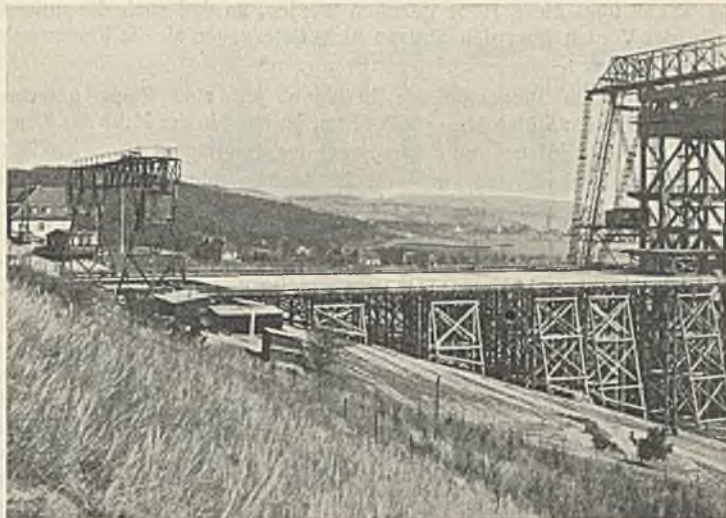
Teilansicht des Gerüsts vor Beginn der Montage.
